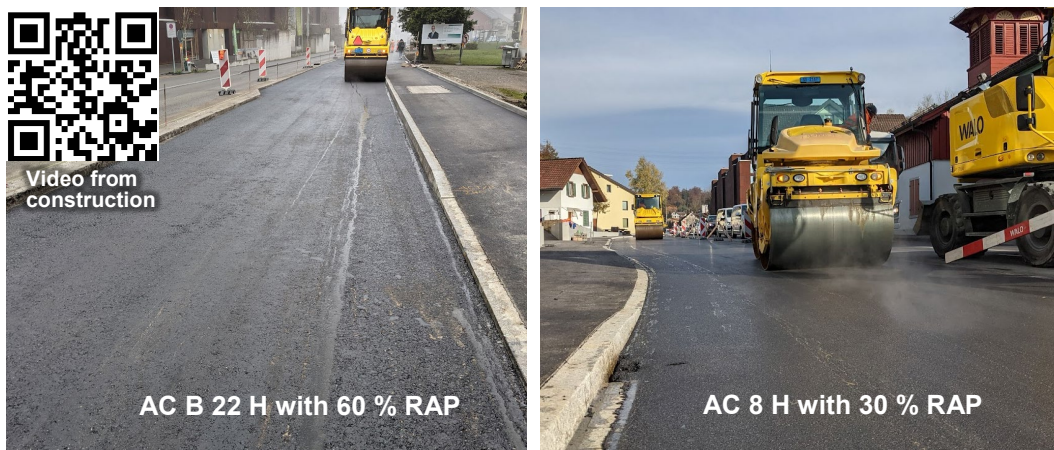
Construction d'une section d'essai HighRAP à Uster
